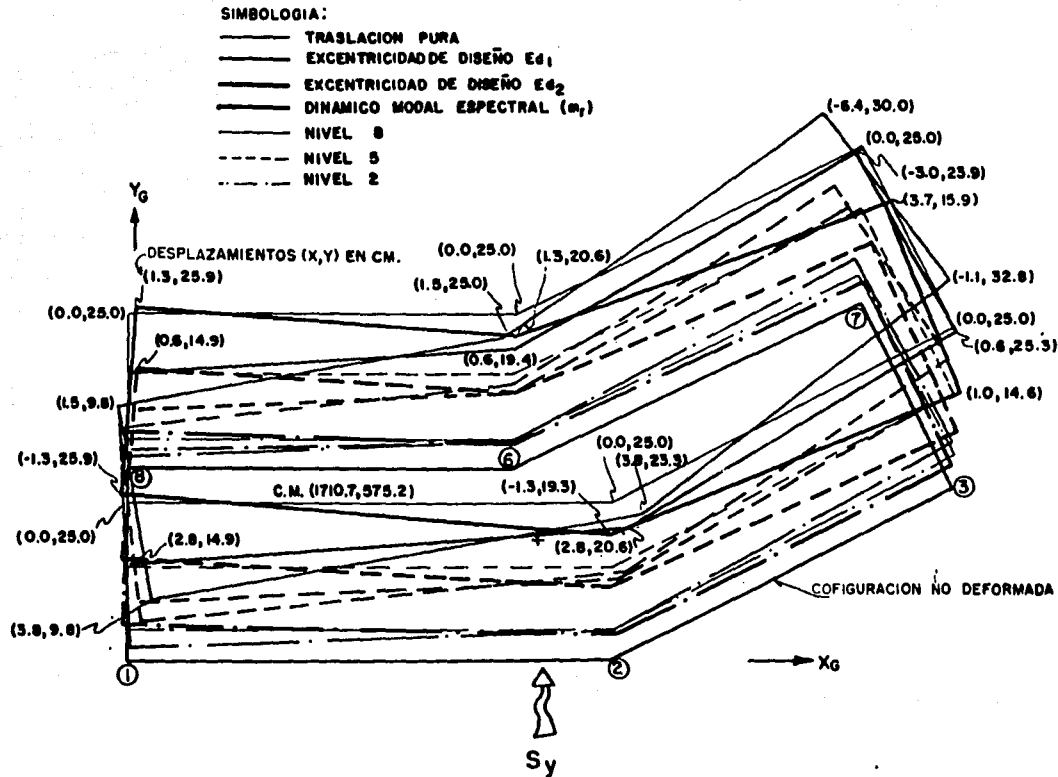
DESPLAZAMIENTOS HORIZONTALES MAXIMOS DE LA ESTRUCTURA EN PLANTA. NIVELES 2,5y8. SISMO EN LA DIRECCION Y. EDIFICIO CASO A.
